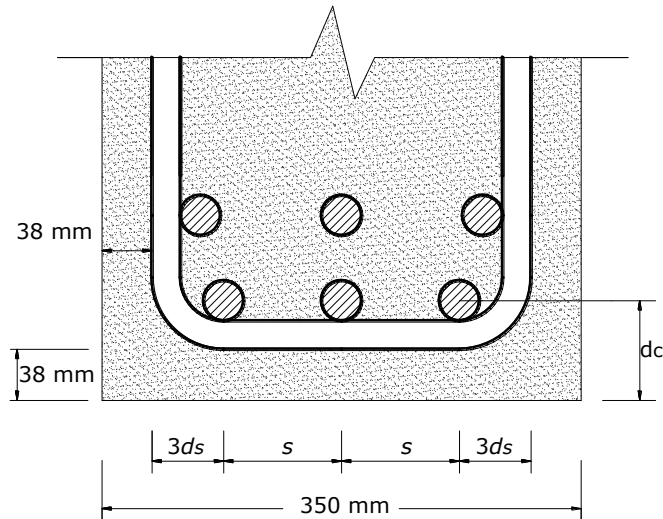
Separación en las armaduras cercanas a la cara de tracción
